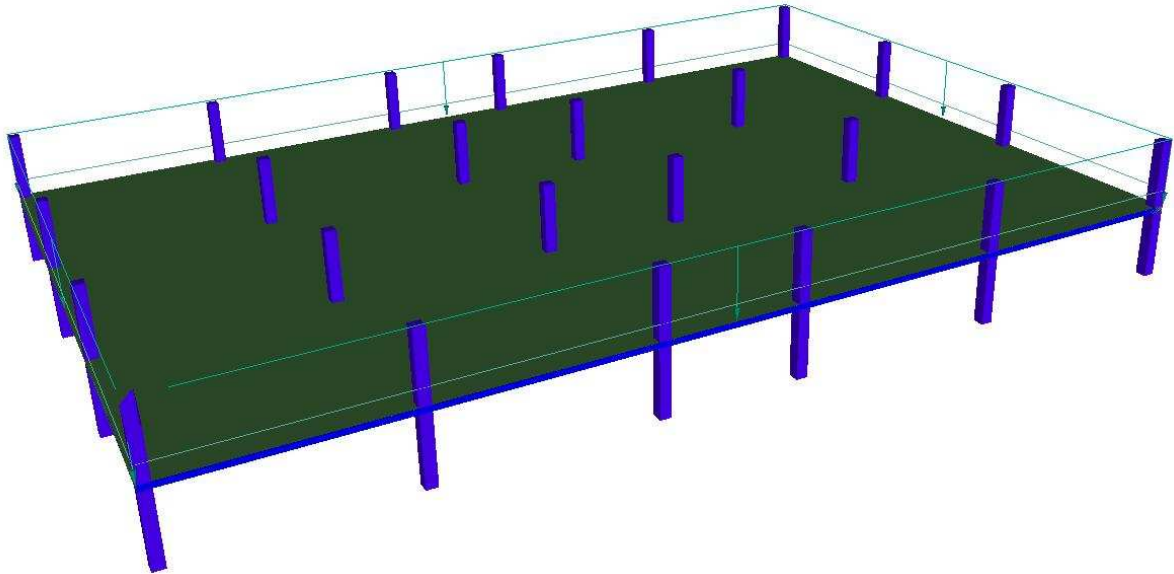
Vista espacial da estrutura com indicação de carregamentos.
